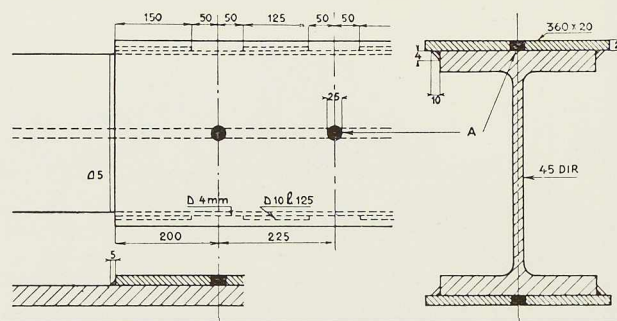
Détail Z de la figure 77 montrant comment sont soudées les semelles de renforcement de la poutre à larges ailes.
